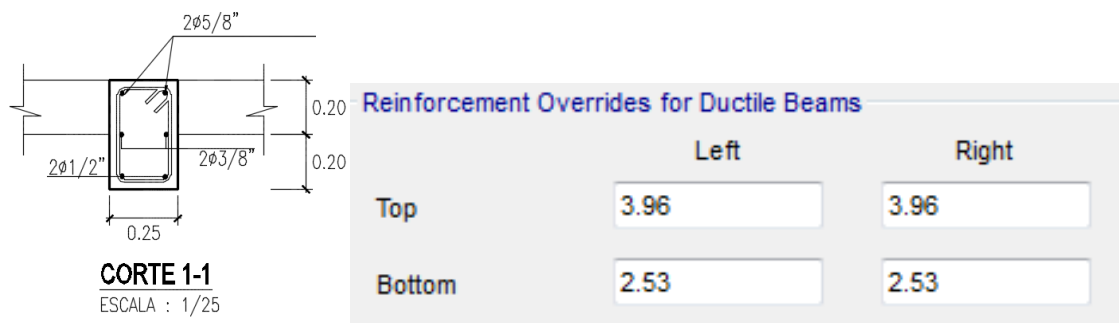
Detalle de refuerzo de la viga V-102, V-202.
